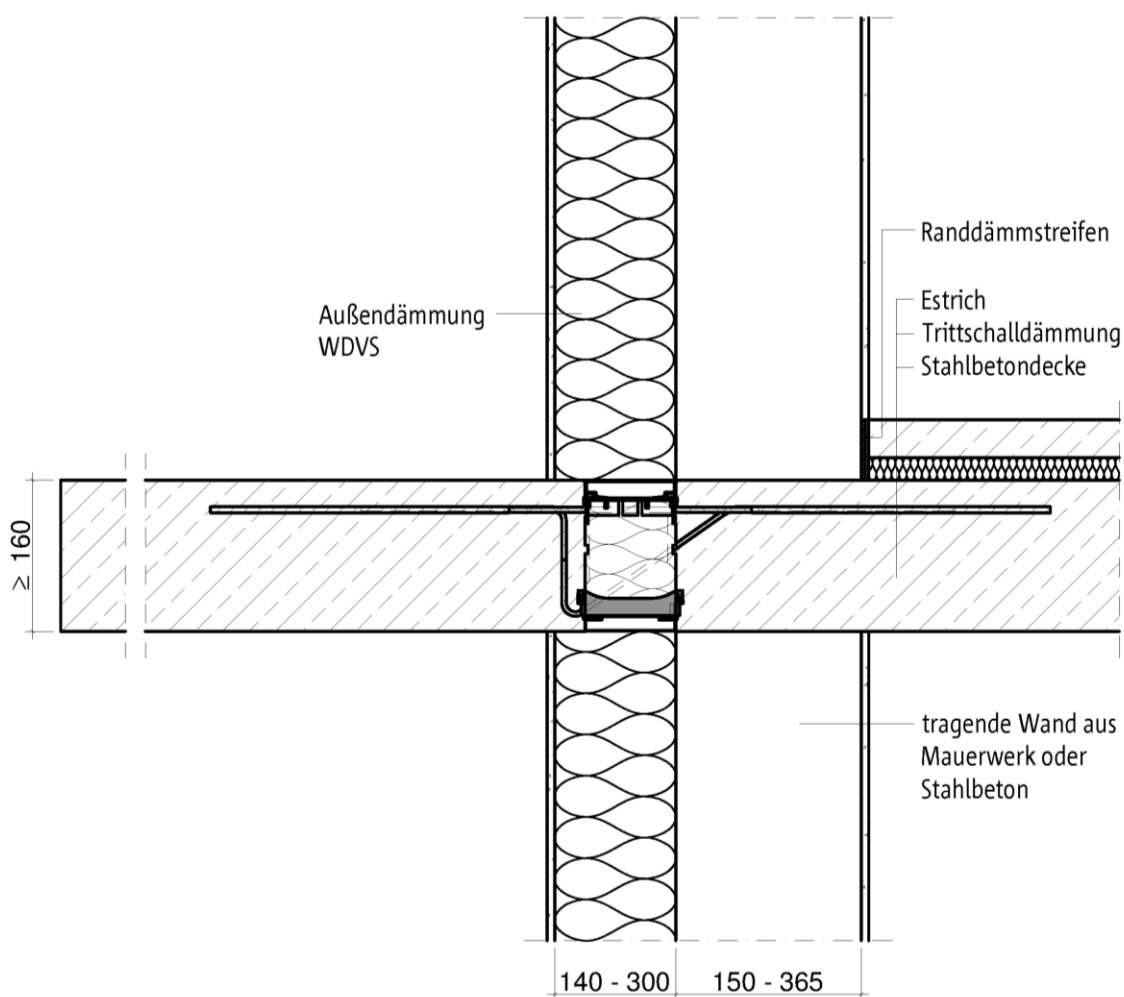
Wandaufbau mit Wärmedämmverbundsystem
